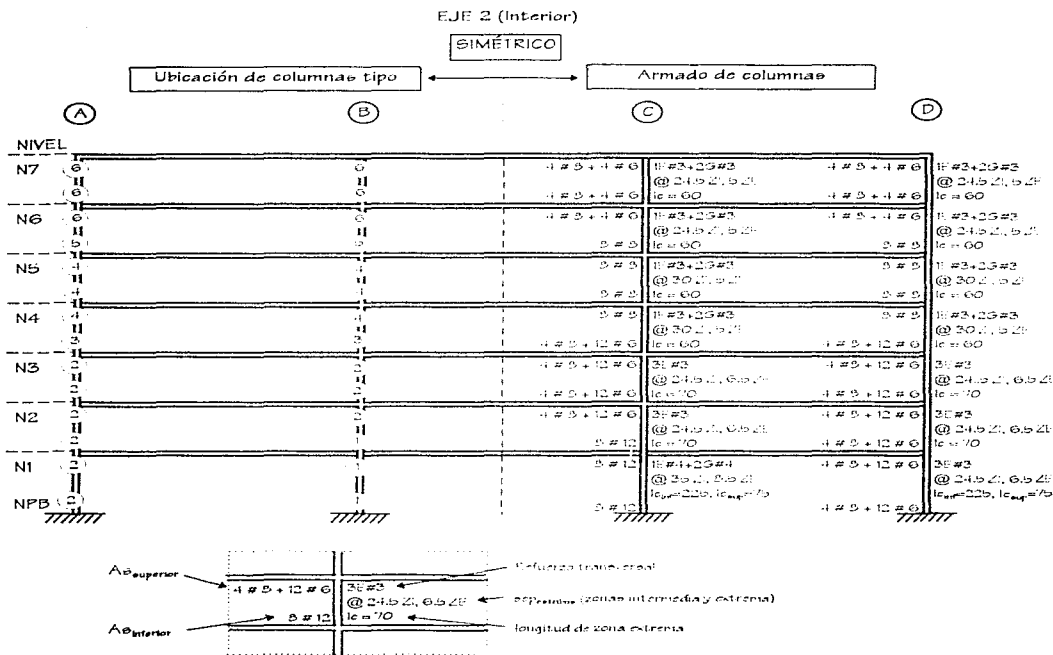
Ubicación de los tipos de armados de las columnas del eje 2 de la estructura diseñada en la zona II
